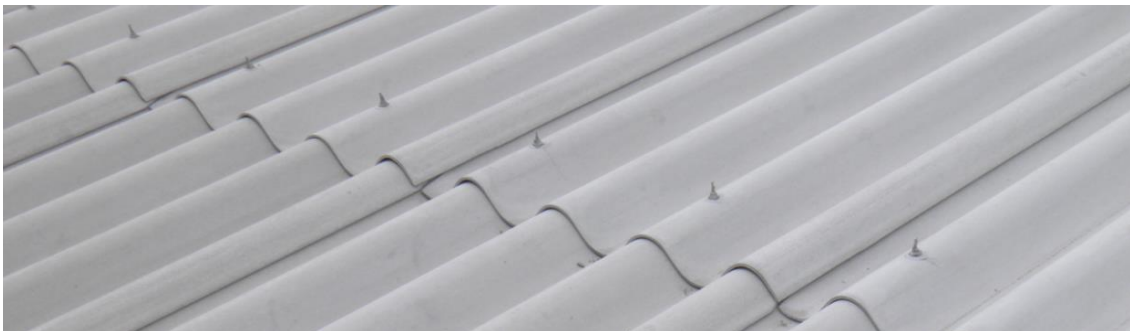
CUBIERTA ELABORADA CON PLANCHAS DE FIBROCEMENTO. FUENTE: (LÓPEZ, 2014)
